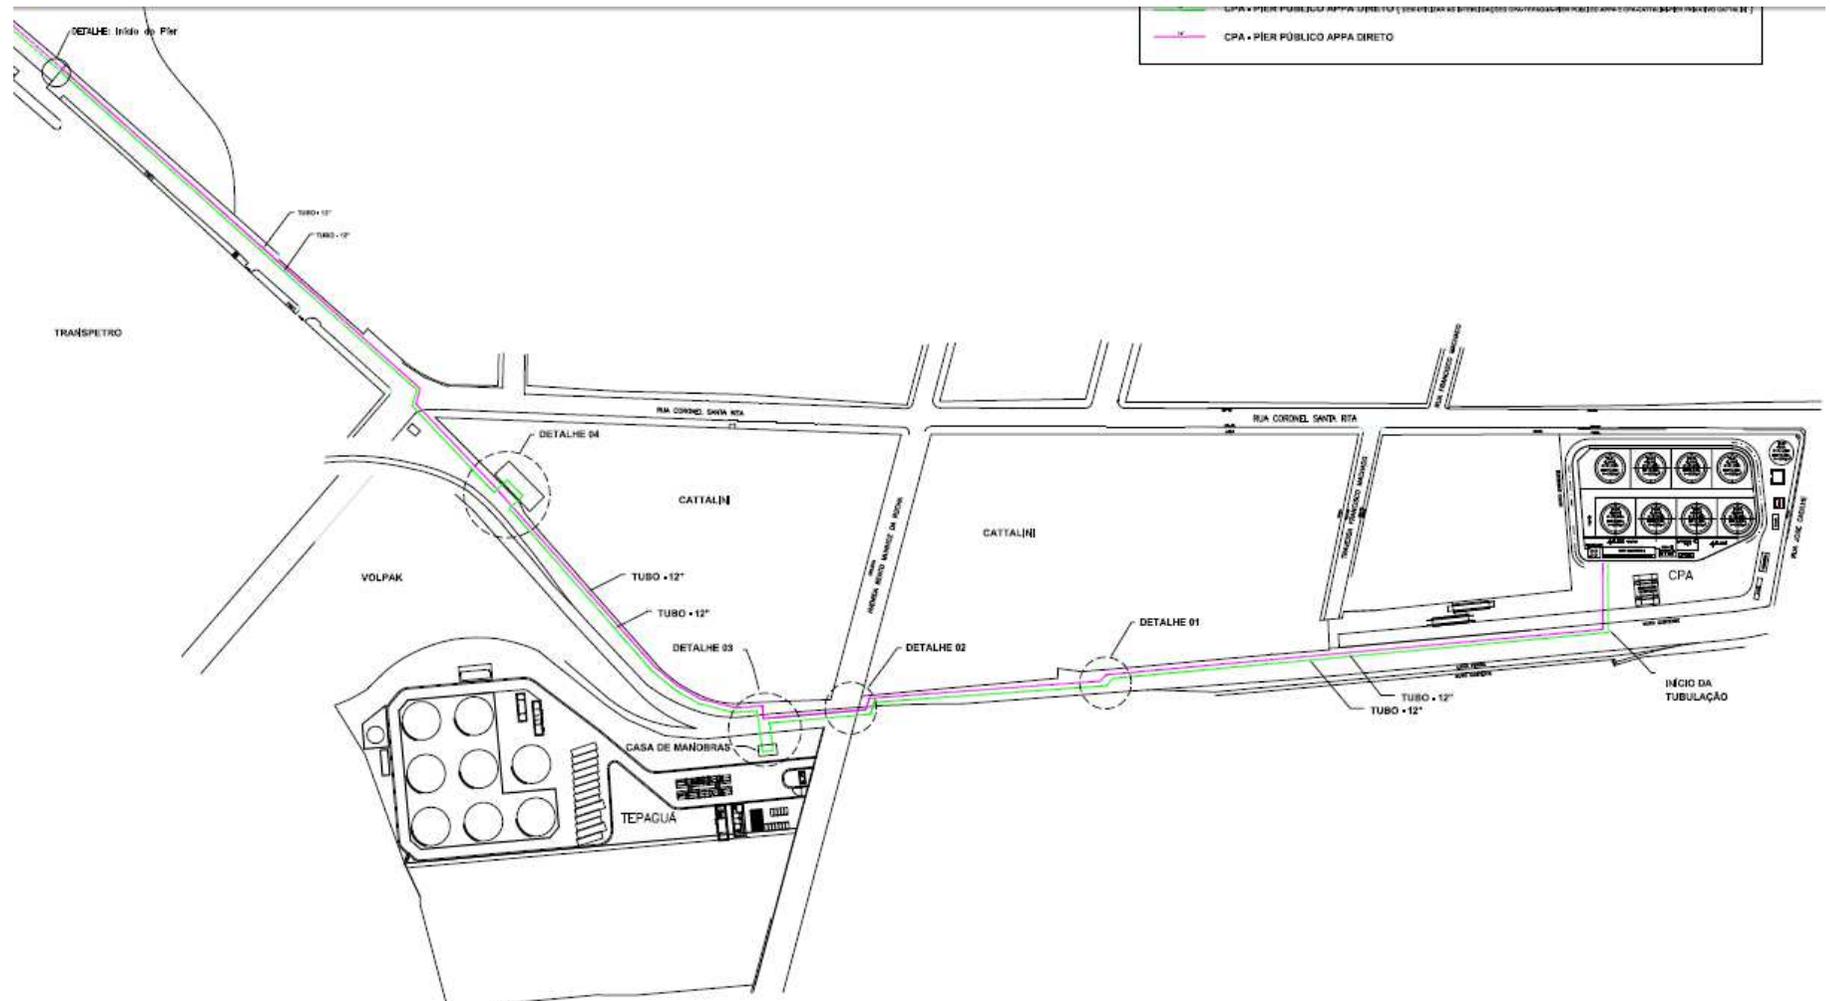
Traçado do duto entre a CPA Armazéns Gerais e o Píer (1)
